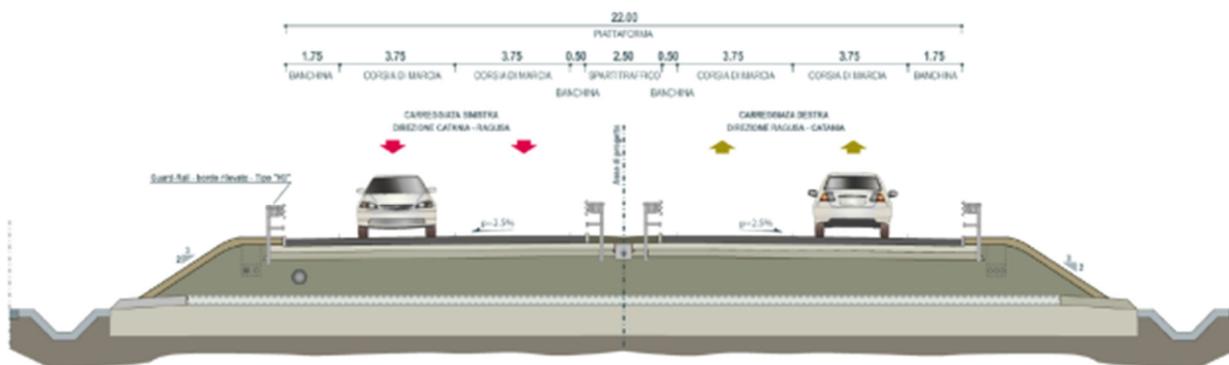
Sezione tipo B del D.M. 5/11/2001 in rilevato
